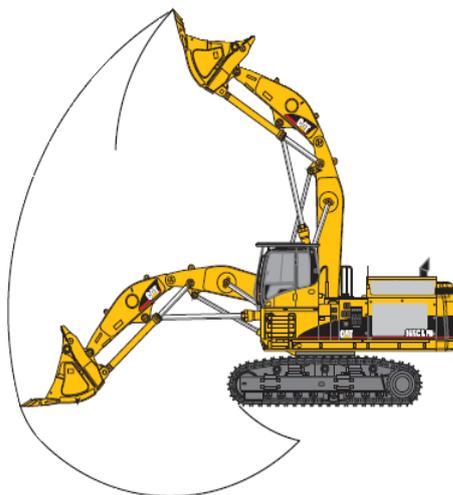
Кинематика движения ковша экскаватора с прямой лопатой
